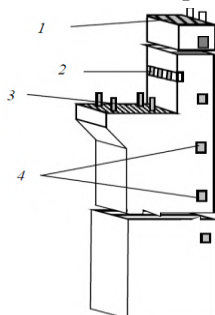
Закладные элементы колонны: 1 – оголовок; 2 – упор подкрановой балки; 3 – опора подкрановой балки; 4 – элемент крепления стеновых панелей
